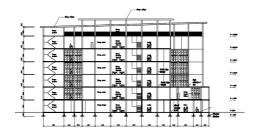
Struktur baja (Sumber : The Construction of Buildings)
